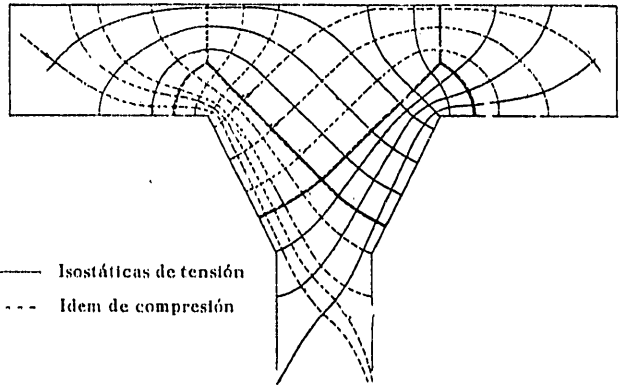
Isostáticas en una viga en T para cargas situadas en la aleta izquierda
